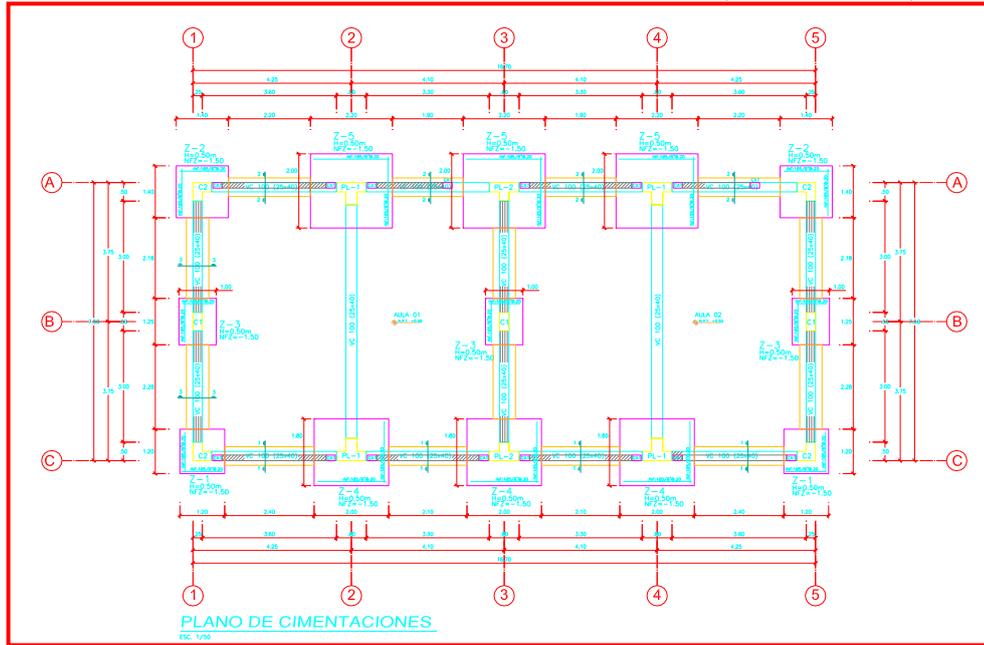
Plano de cimentación E-01 de la I.E. N° 586, El Dorado
